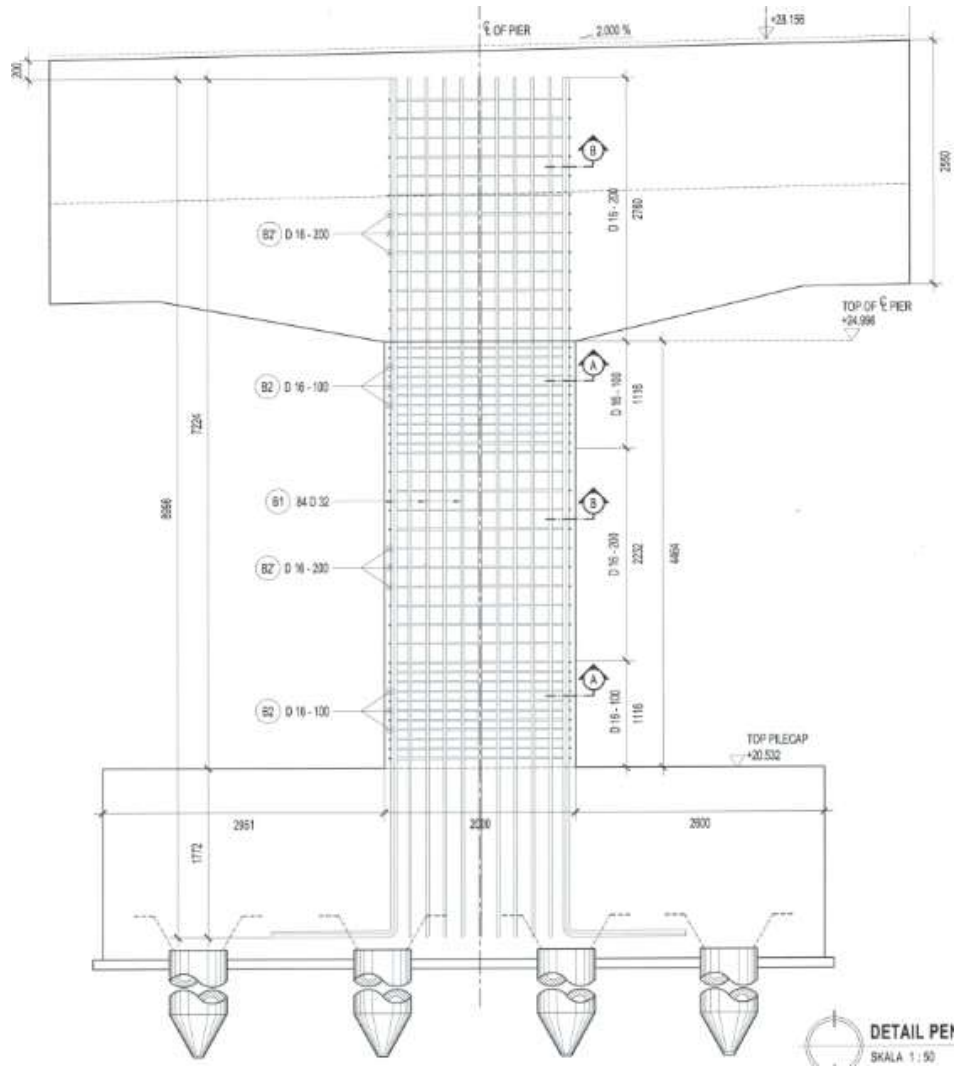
Denah dan bentuk struktur *pile cap* *Pier* PN1
